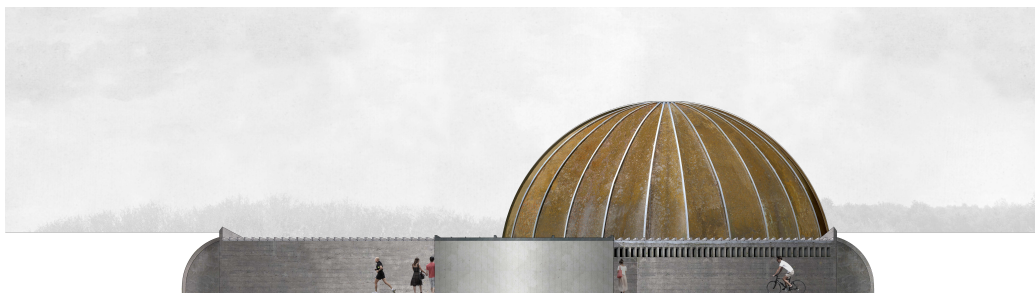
Prospetto esterno del nuovo ingresso (EdA)
